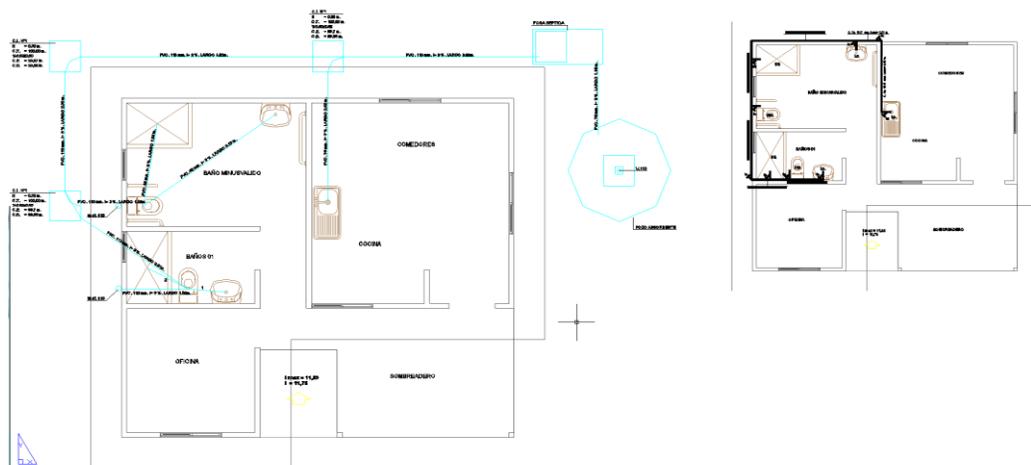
Vista instalación alcantarillado y agua potable camarín vertedero.
